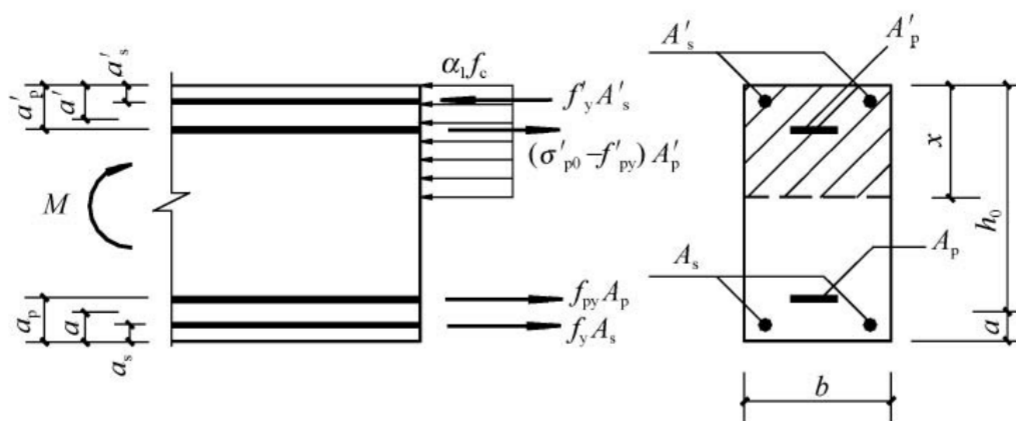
矩形截面受弯构件正截面受弯承载力计算
